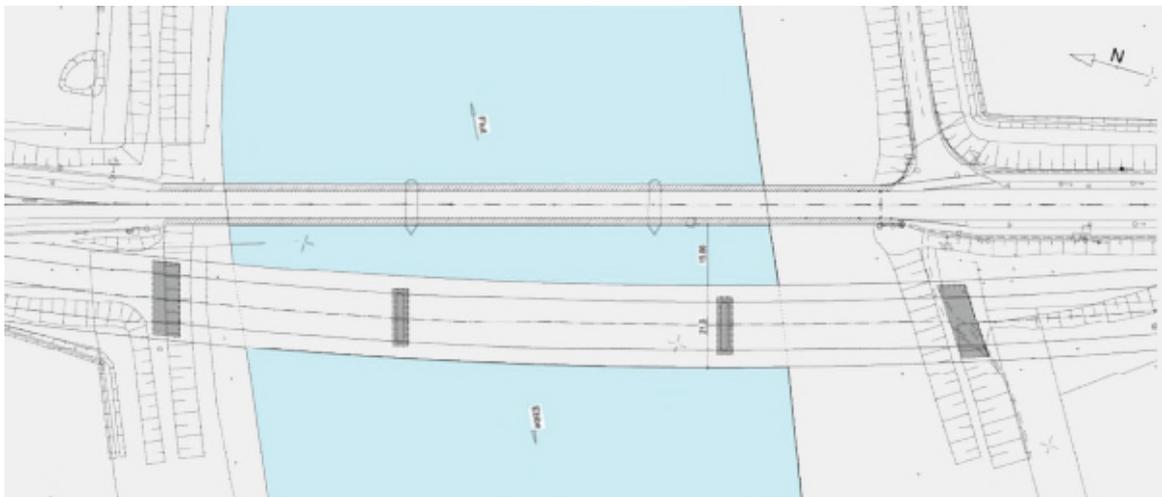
Lageplan der Überbauvariante 1.1 Durchlaufträgerbrücke in Verbindung mit Trassenvariante 2 gemäß /3/
